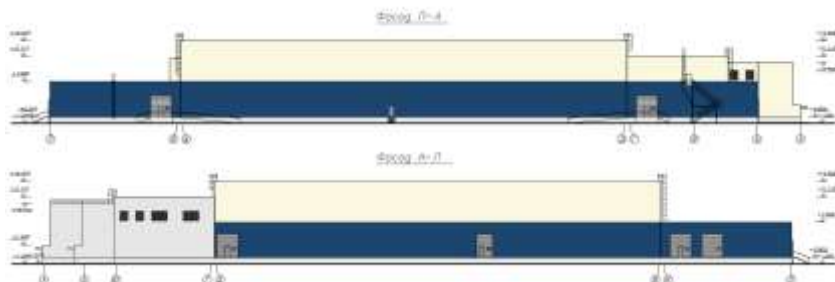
Фронтальний та тильовий фасади складської будівлі
